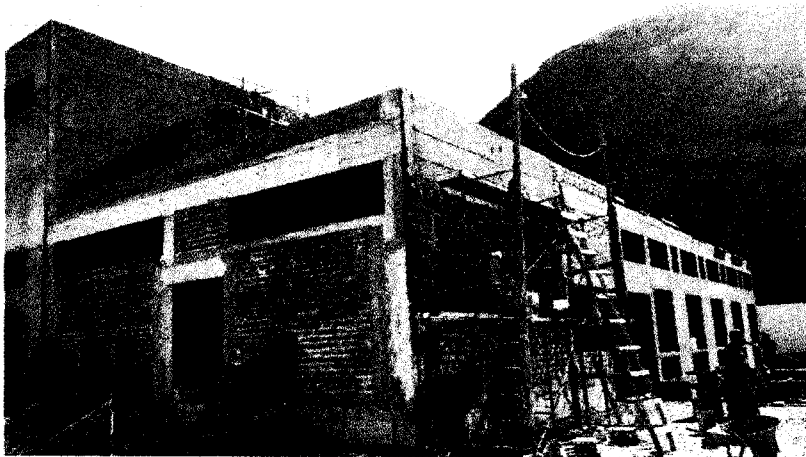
Tarrajeo en muros exteriores. Fachada Posterior en la zona de Almacén – Frío.
